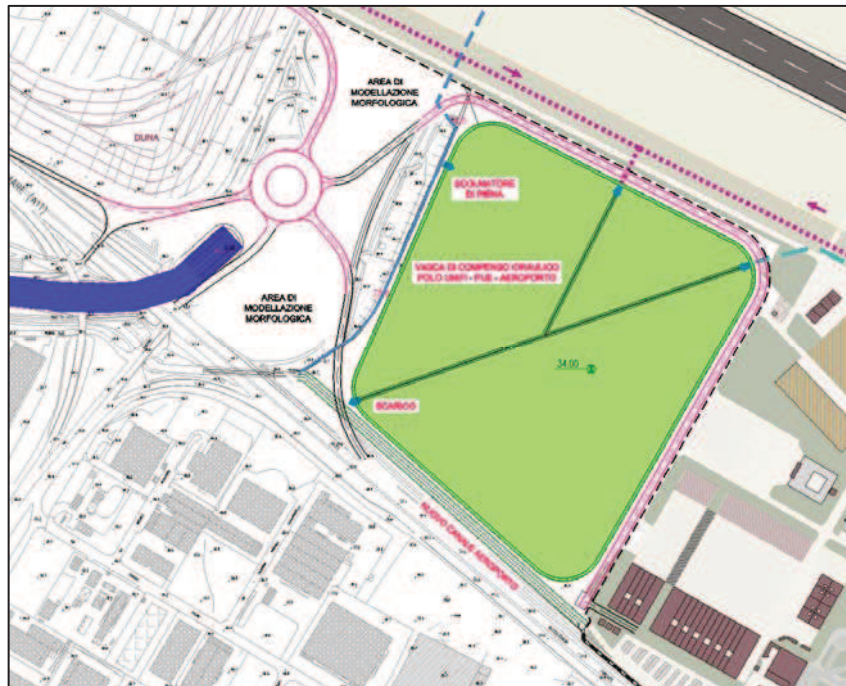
Stralcio Planimetrico della vasca di espansione acque Basse in progetto a servizio di:
